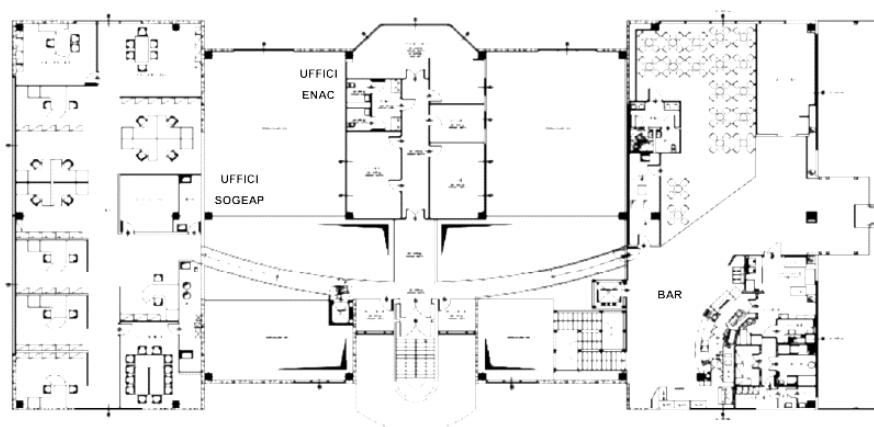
Configurazione fisica attuale: aerostazione passeggeri, planimetria piano primo
